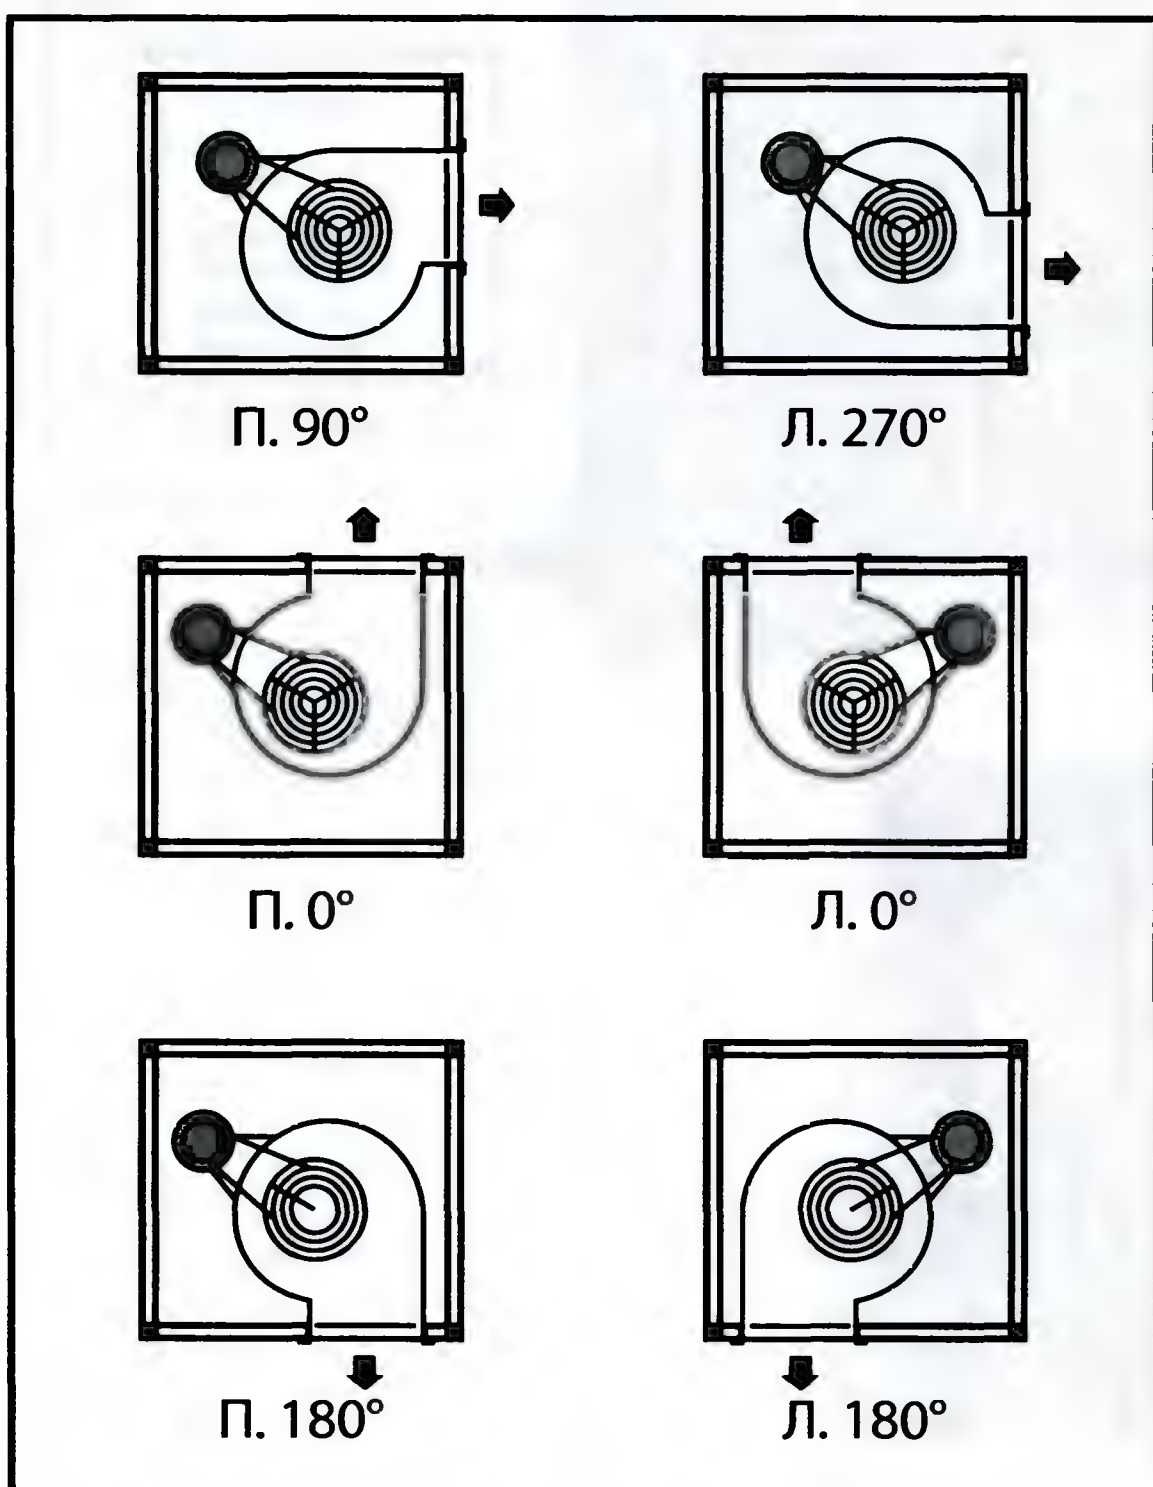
Положения корпуса вентилятора двухстороннего всасывания
